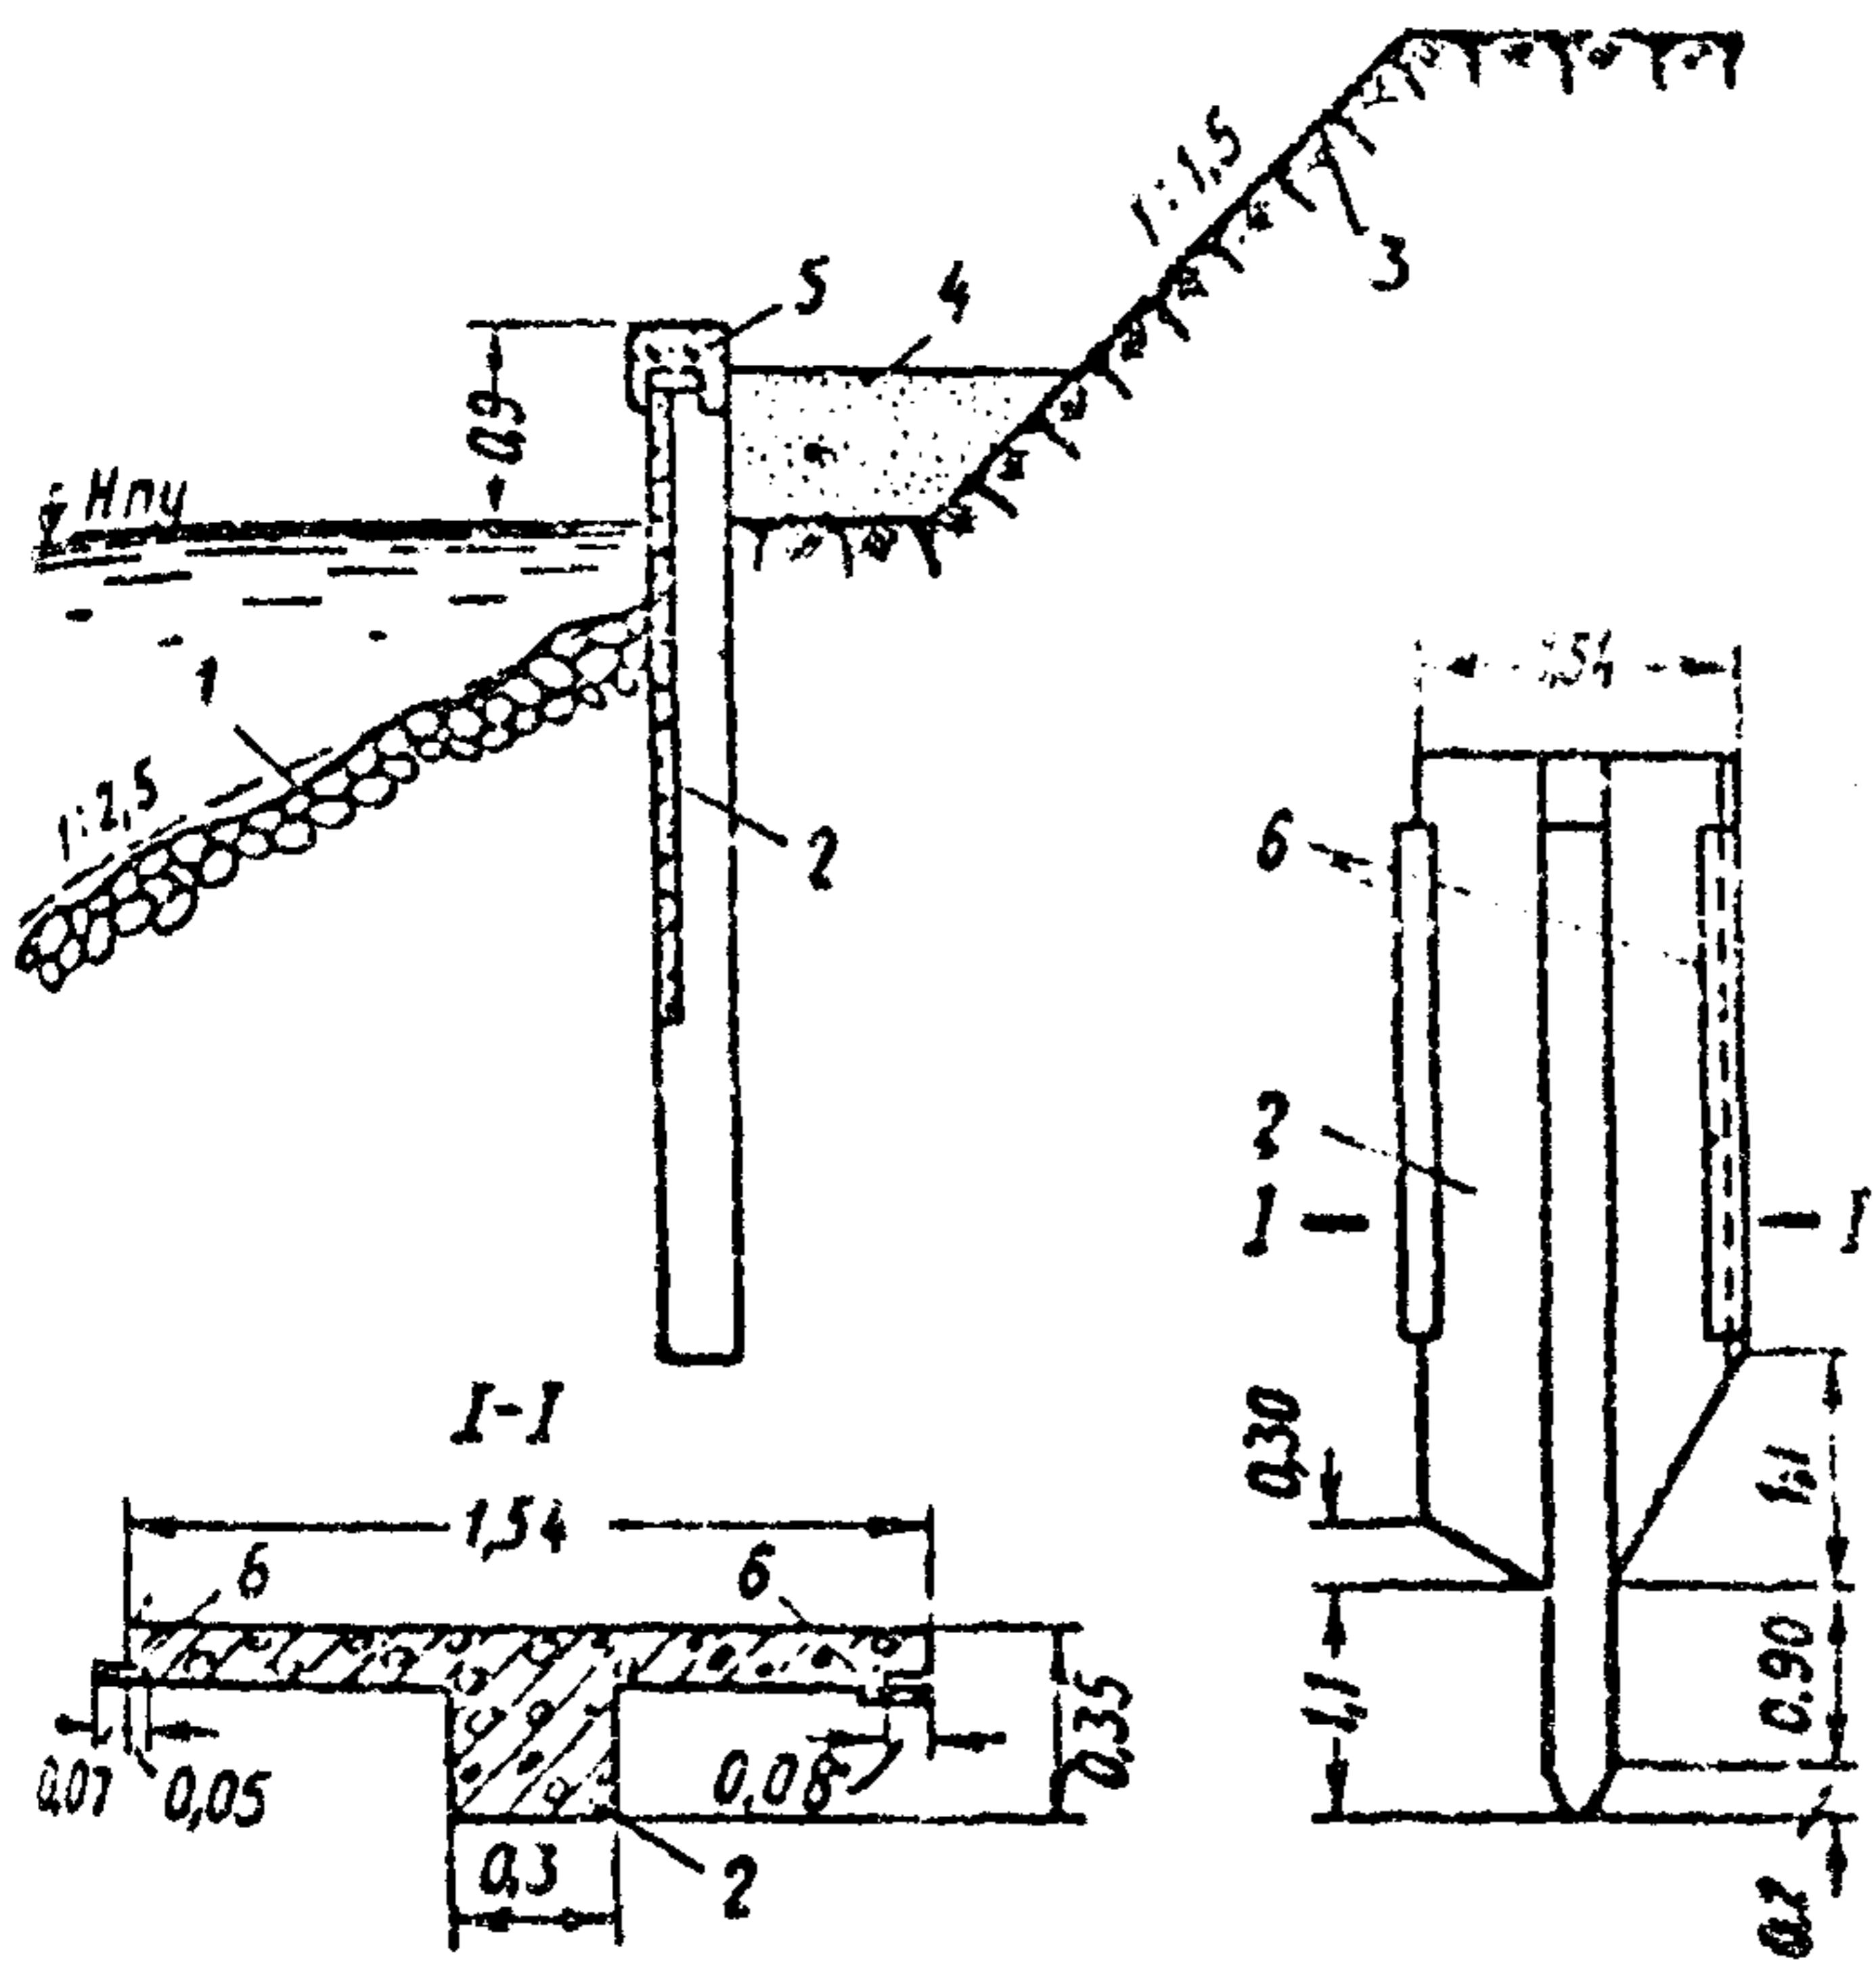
Крепление откосов вертикальными стенками из железобетонного шунта.
